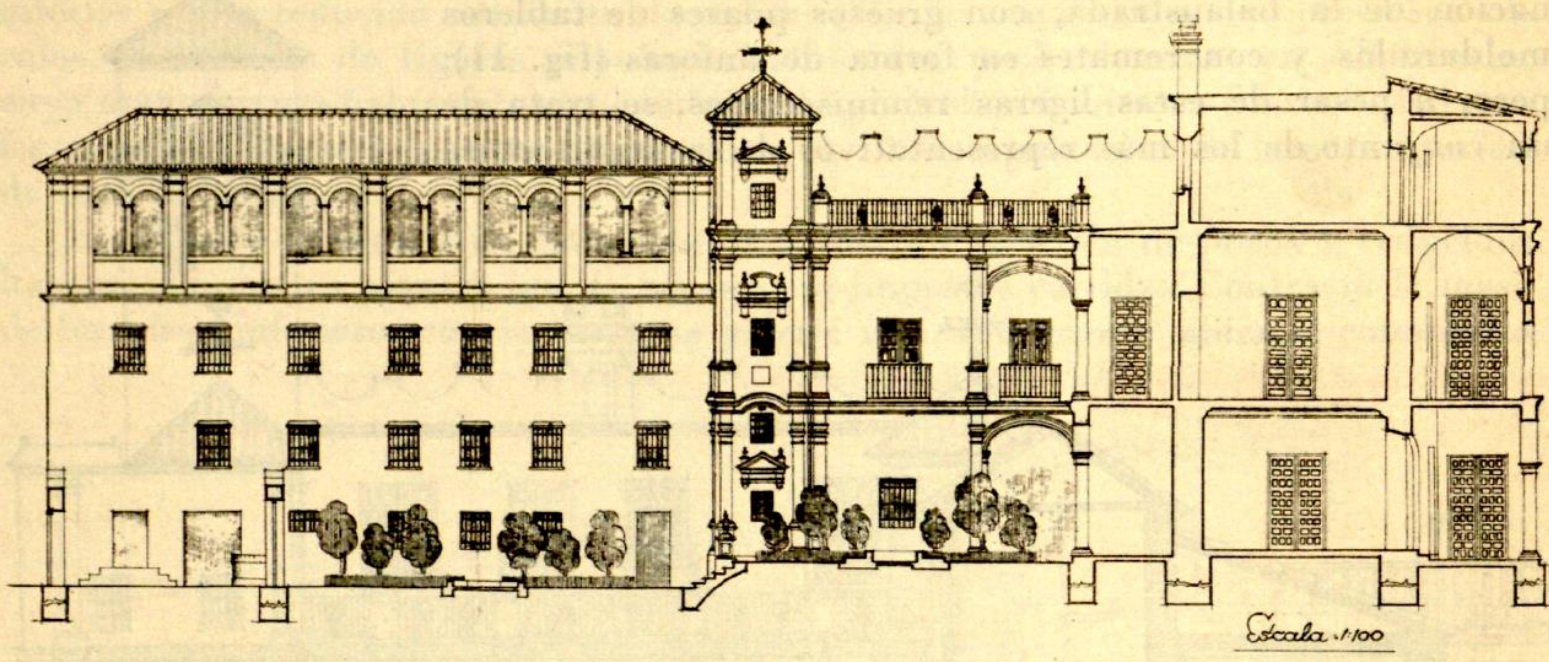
Plano de la fachada lateral. Fernando Chueca, 1945.
